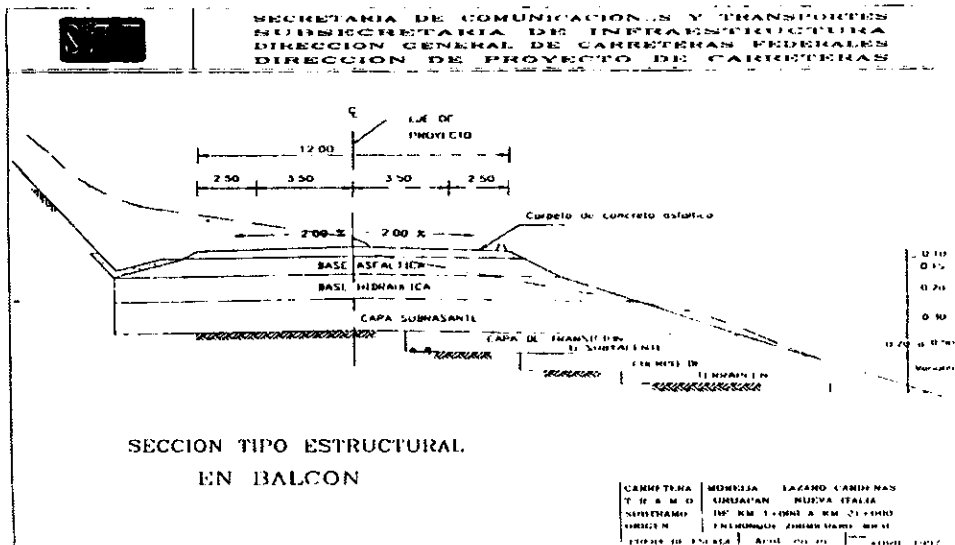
, 4.3 y 4.4 Secciones tipo de construcción.
